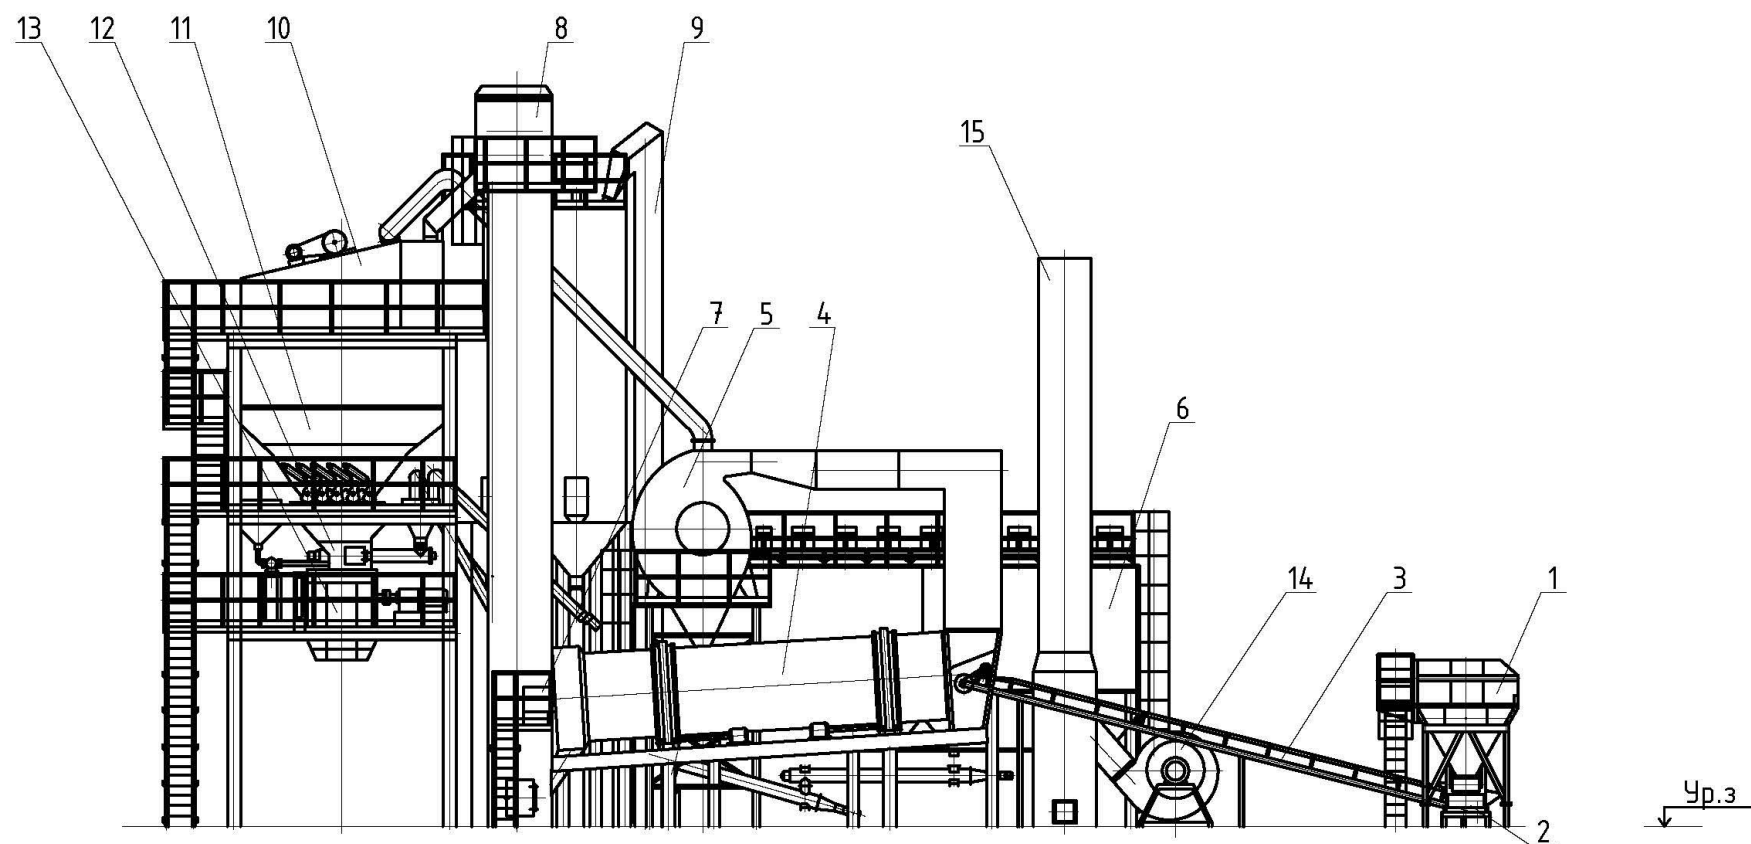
Схема асфальтобетонной установки HLB-3000
